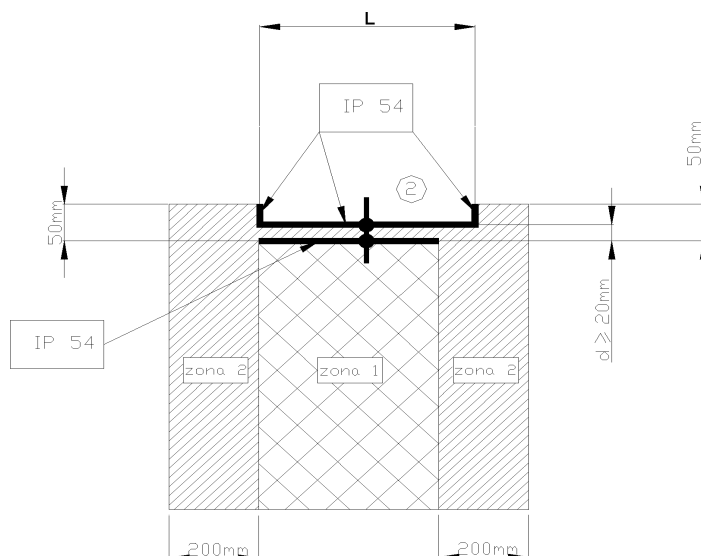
Barreira de Vapor Horizontal - Tipo 2
